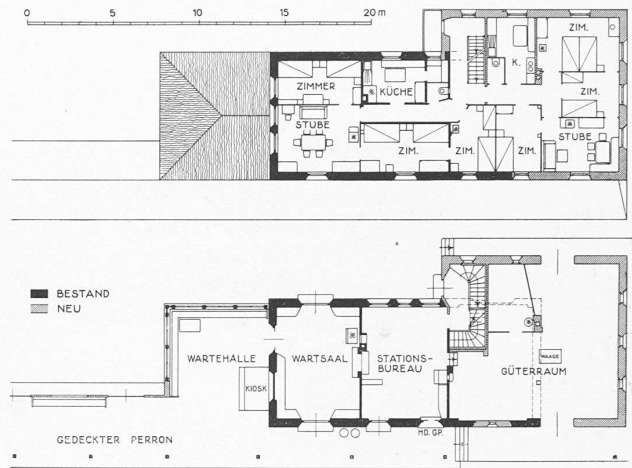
Erweiterte Grundrisse, Parterre und Obergeschoss. — 1 : 400.
